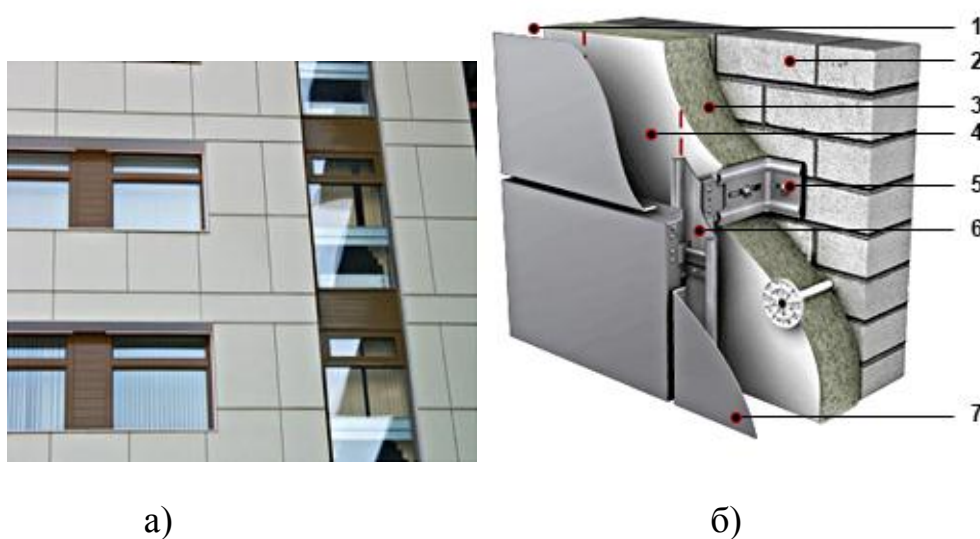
Схема утеплення стін за методом «вентильованого фасаду»: а) – принципова схема утеплення; б) – загальний вигляд утепленого фасаду 1 – стіна з нанесеним утеплювачем; 2 – зовнішня стіна; 3 – плитний утеплювач; 4 – повітряний прошарок; 5 – анкерні кріплення ізоляції; 6 – захисна пливка; 7 – захисне декоративне лицювання
